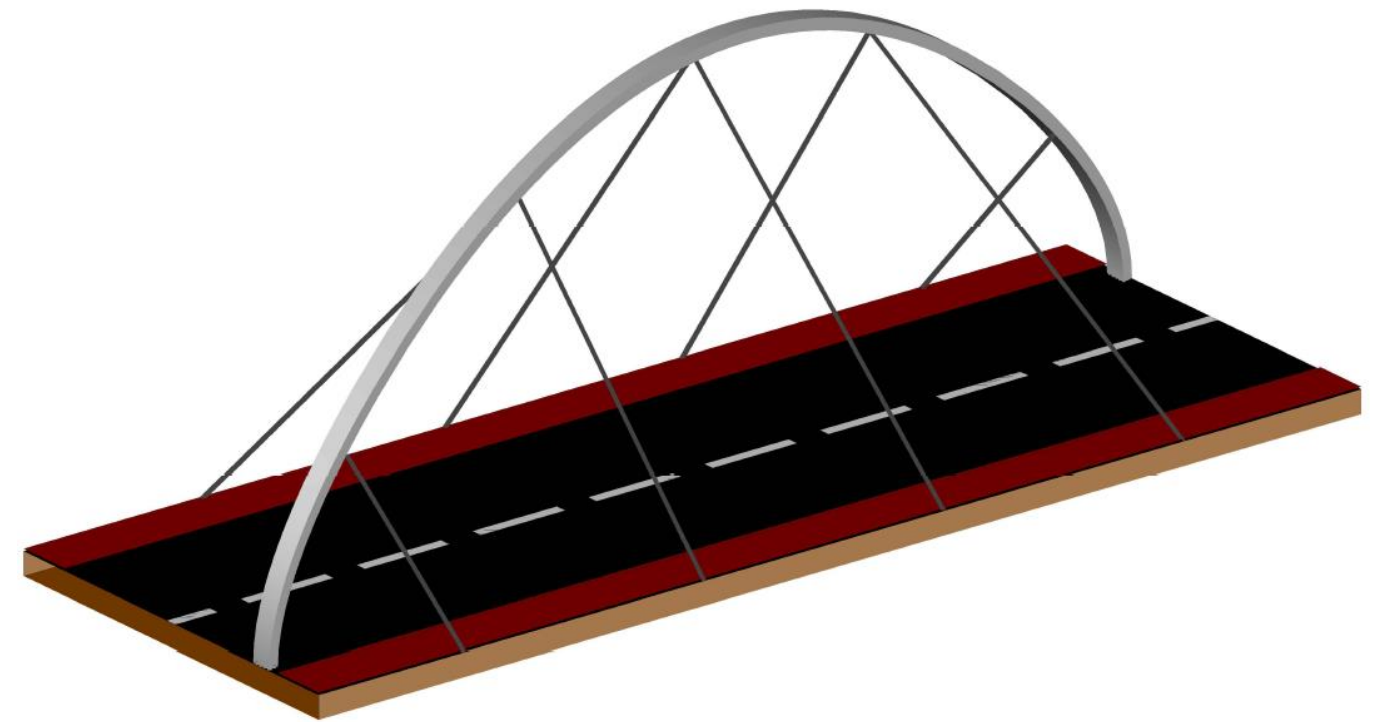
VISTA GENERAL ALTERNATIVA 2.
